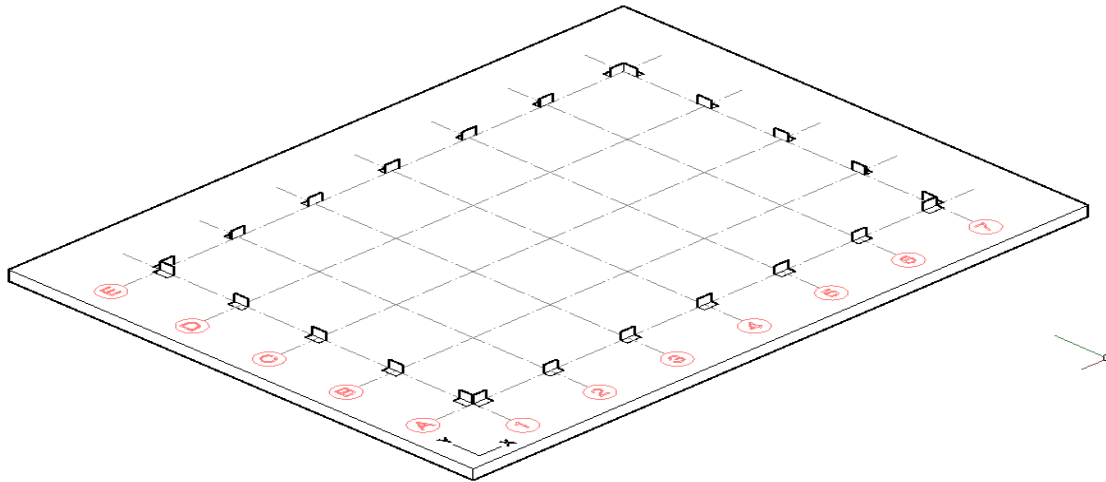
Isometría de los ángulos colocados en el piso que servirán de topes para realizar los paneles
